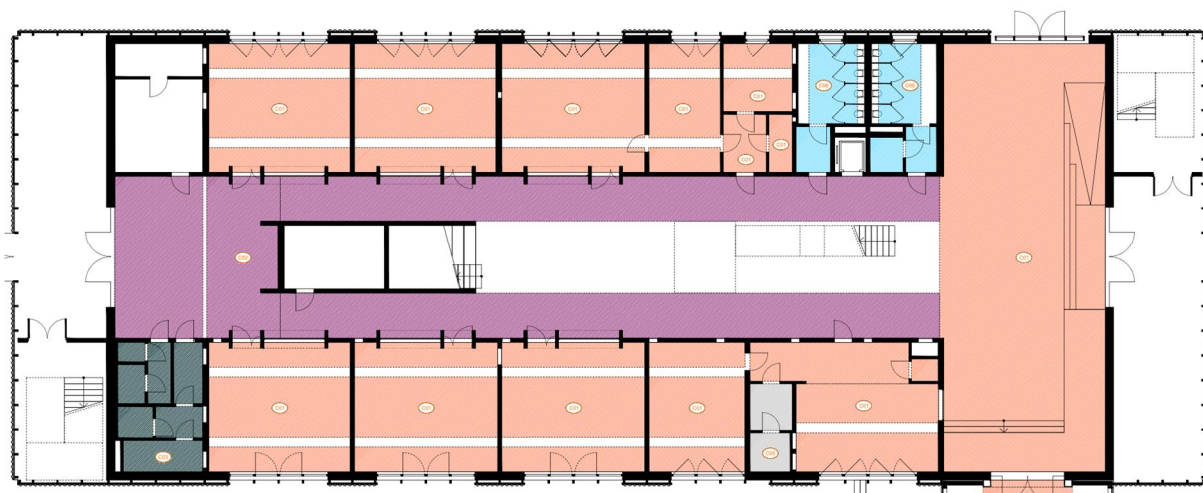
Planimetria del piano terra con indicazione dei trattamenti acustici da realizzare nell'atrio di ingresso (controsoffitto fonoassorbente C01) e nel corridoio (controsoffitto fonoassorbente C02)
